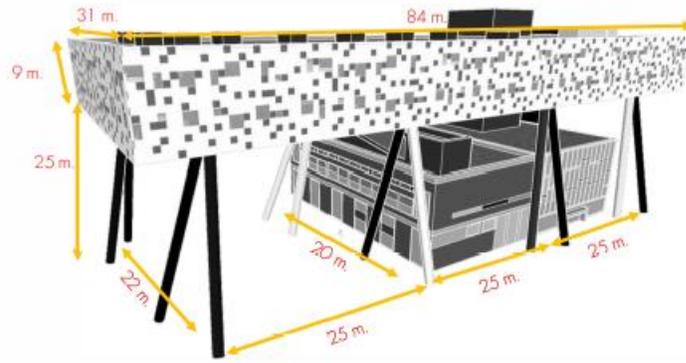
Dimensiones generales del Centro de Diseño Sharp-Ontario College of Art & Design
